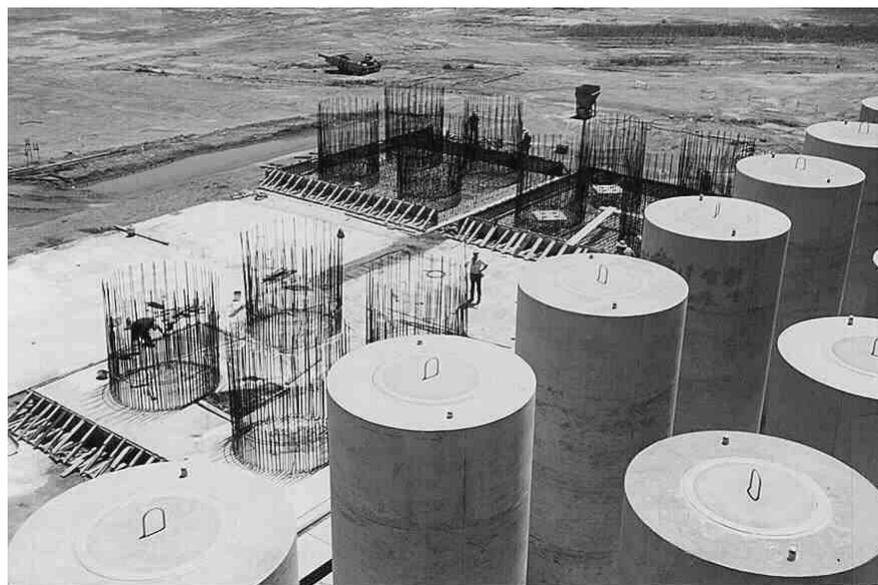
Instalação de silos verticais de concreto armado para armazenar CNQ em instalações externas.
